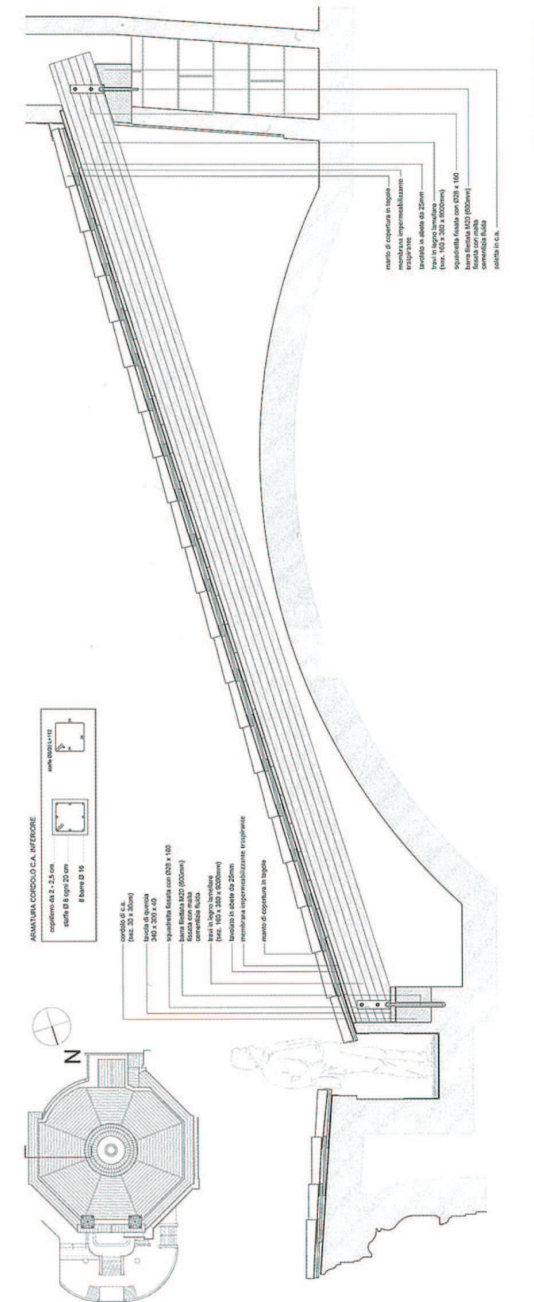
Sezione di dettaglio della nuova struttura di copertura
